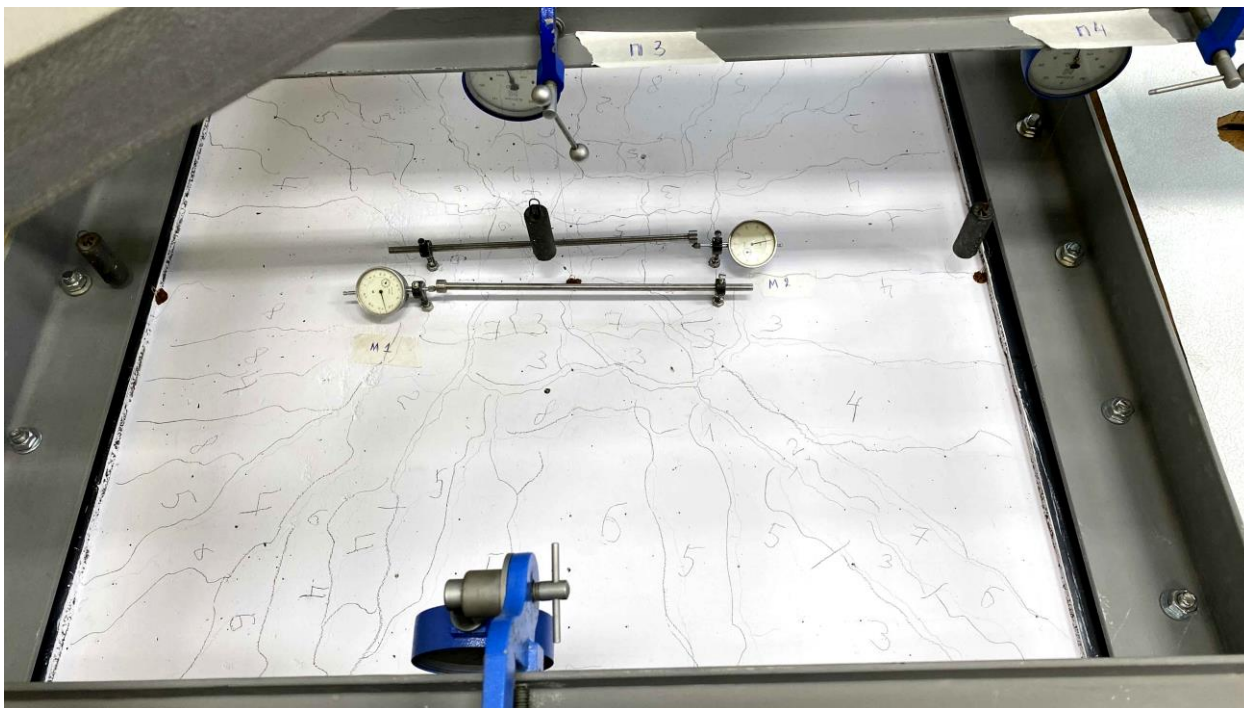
Испытанная модель железобетонной плиты со сферическими пустотообразователями
